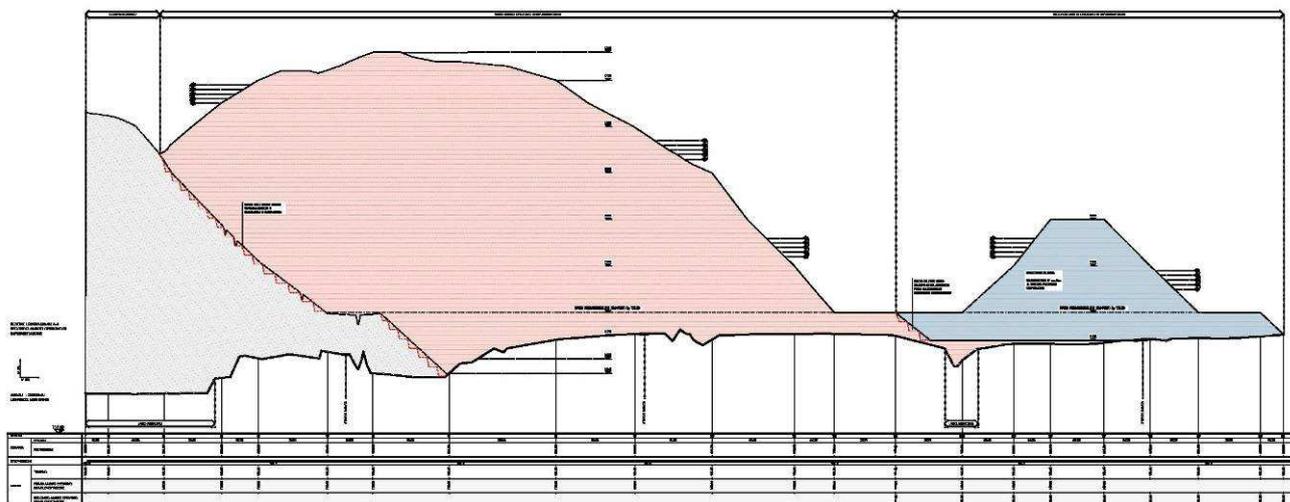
Sezione longitudinale con il Secondo Ambito d'Implementazione
